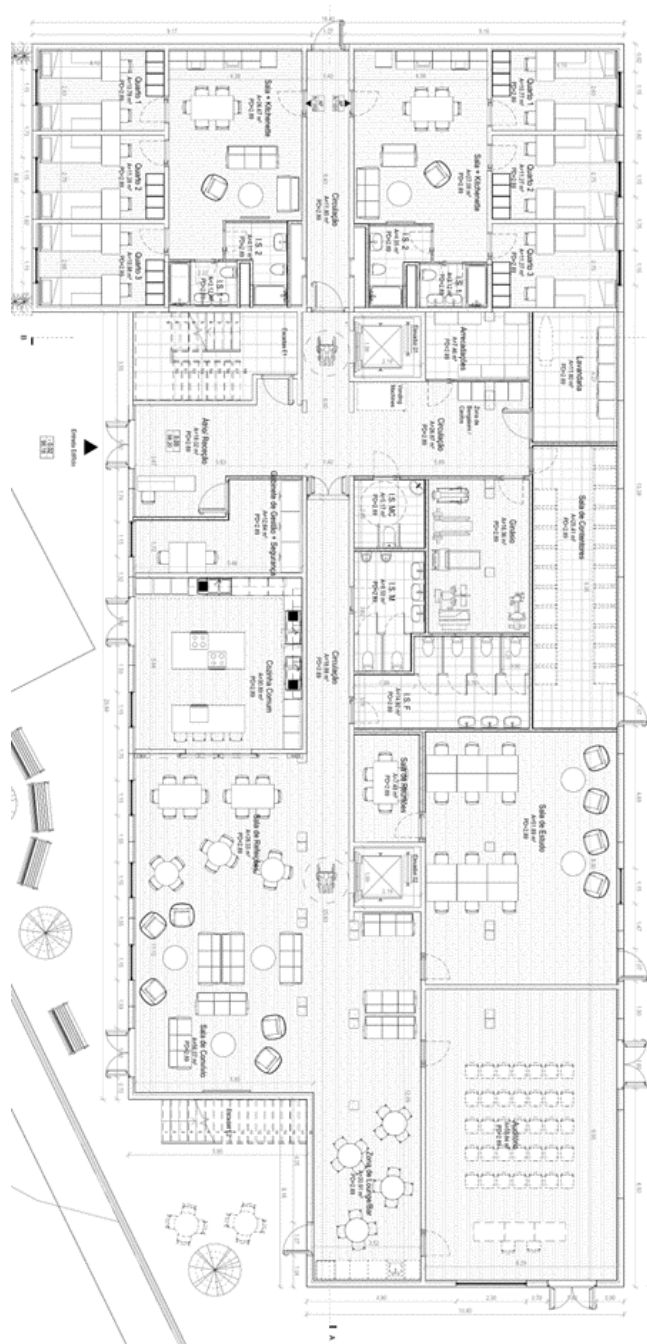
Planta do rés do chão - Residência em Benfica (sem escala)
